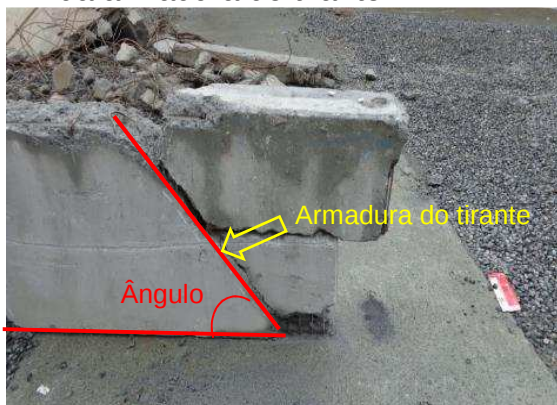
Viga VP-02 Eixo 02. Detalhe da Figura anterior com armadura do tirante sem dobra, diferente do previsto no projeto estrutural
